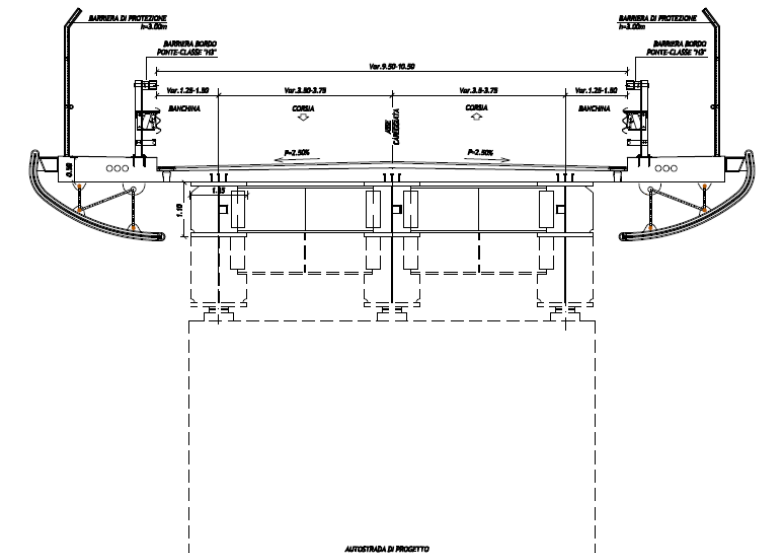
SEZIONE TIPO IMPALCATO CAVALCAVIA DI STRADA PROVINCIALE
